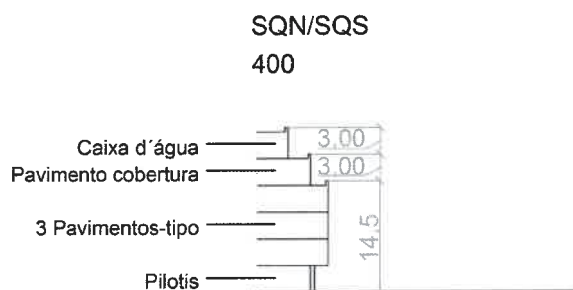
Proposta de alturas para edifício de superquadra (SQN/SQS 400): corte esquemático
